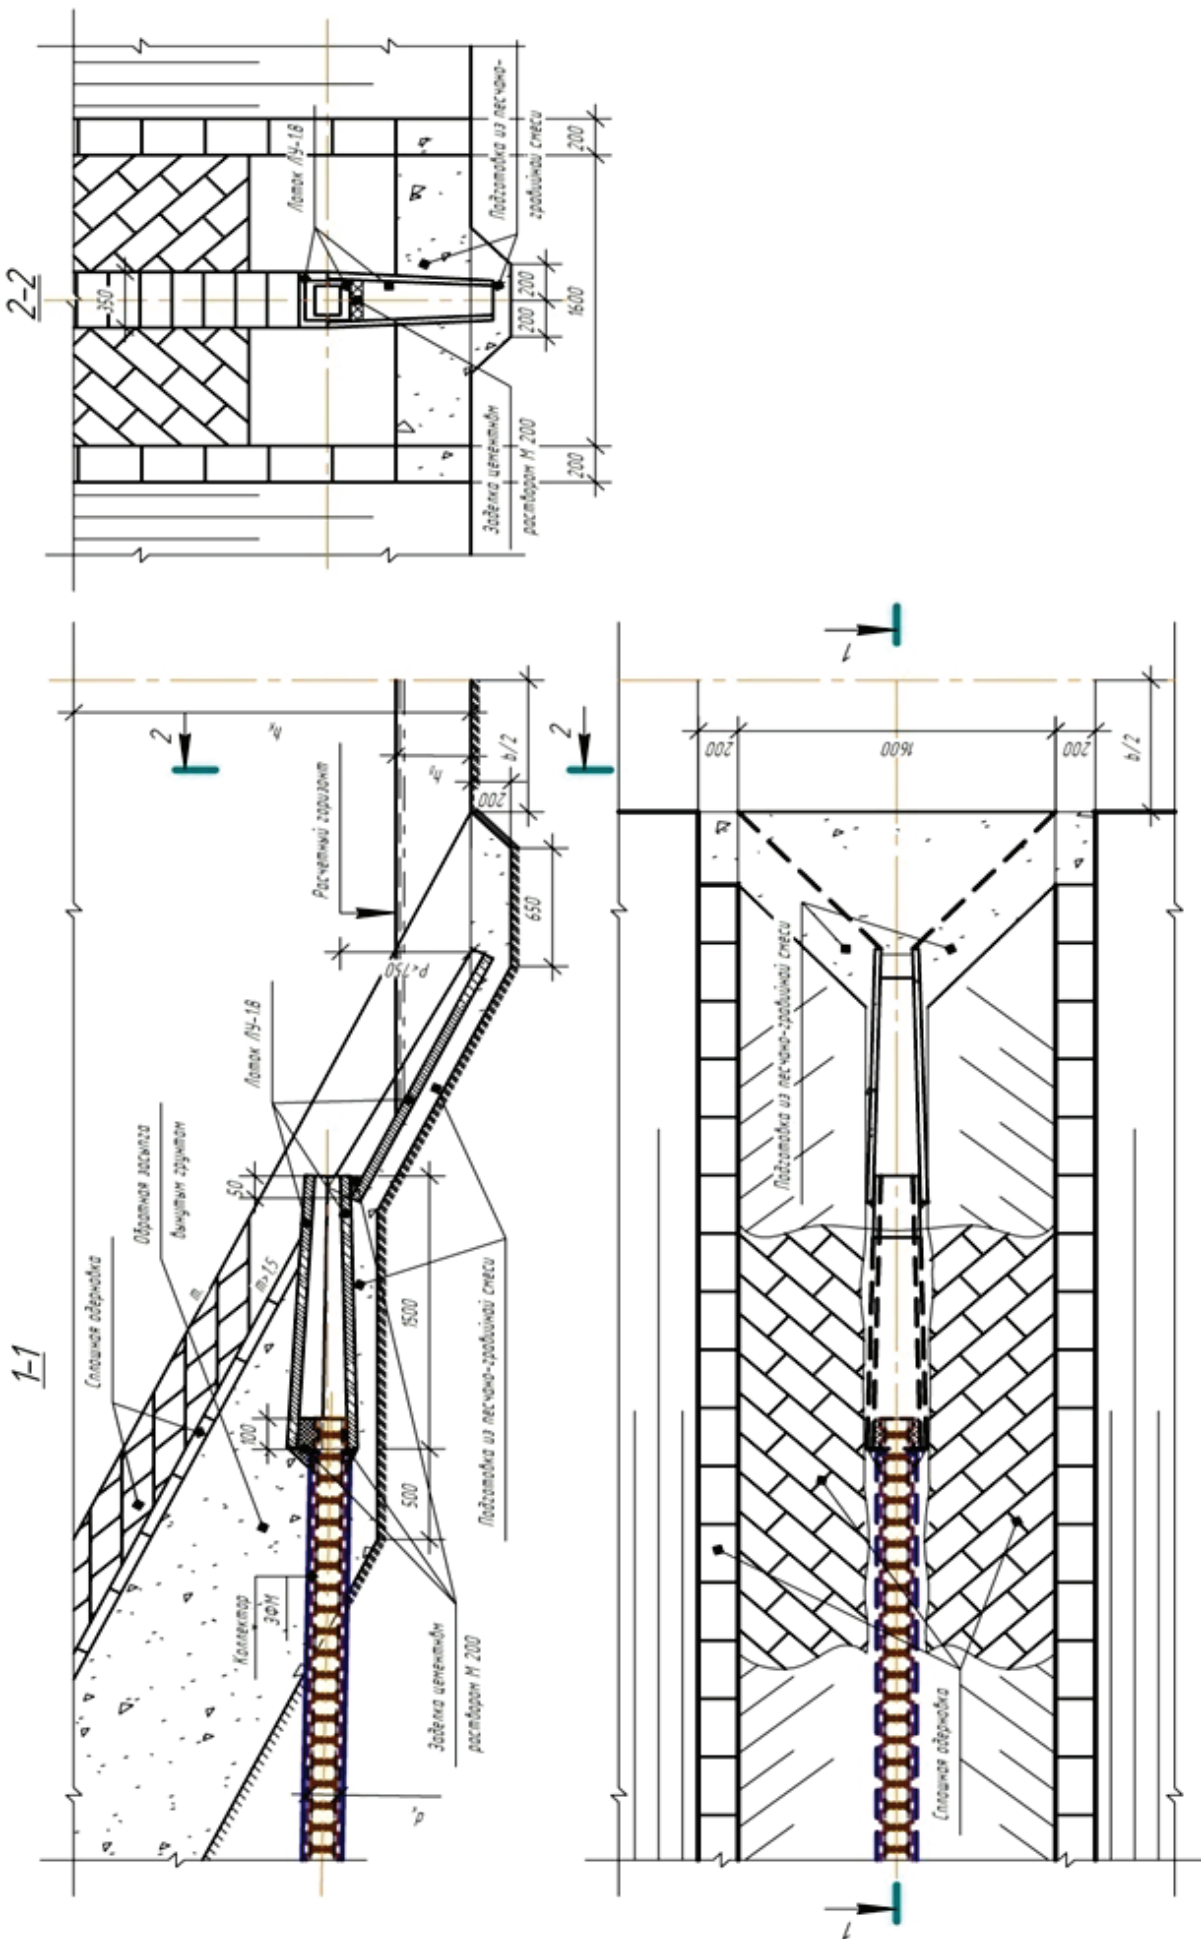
Железобетонное дренажное устьевое сооружение УЛ-1-1.8-75 из корычатых блоков ЛУ-1,8
